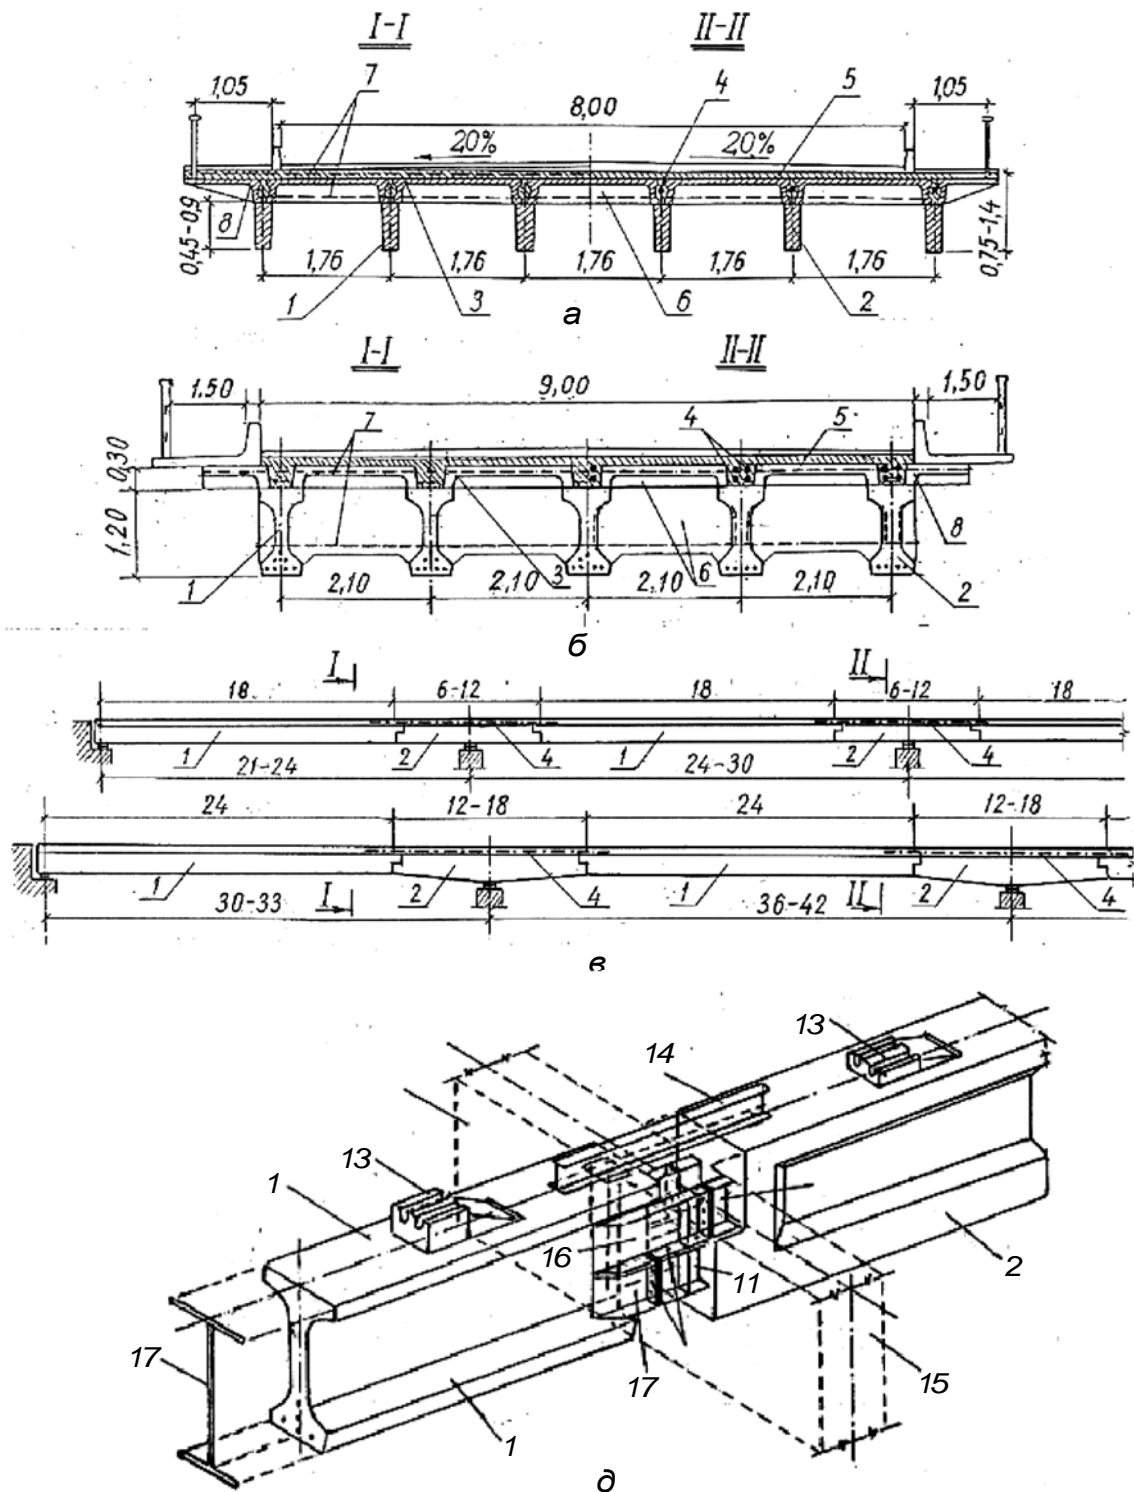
Конструктивне вирішення збірно-монолітних нерозрізних прогонових будов мостів: а і б – поперечні перерізи; в – конструктивні схеми; г – стик прогонових балок 1 з надпорними 2 і діафрагмами 15; 4 – напружена армура в надпорній зоні; 5 – бетон замонолічування; б – діафрагма; 7 – армура діафрагм; 9-16 – закладні елементи стиків балок 1 і 2
